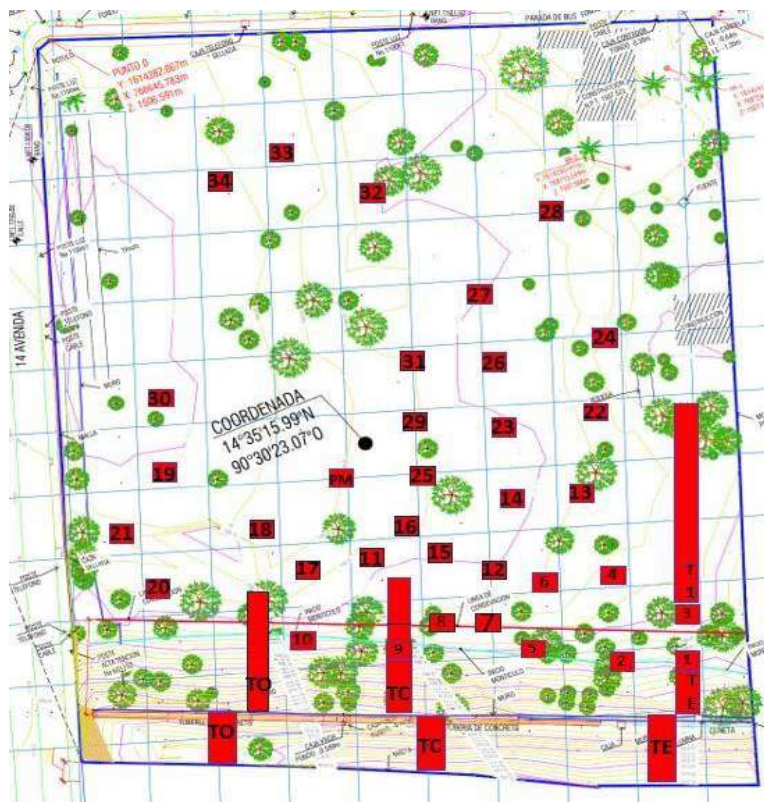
Plano final con todas las excavaciones y trincheras realizadas.
